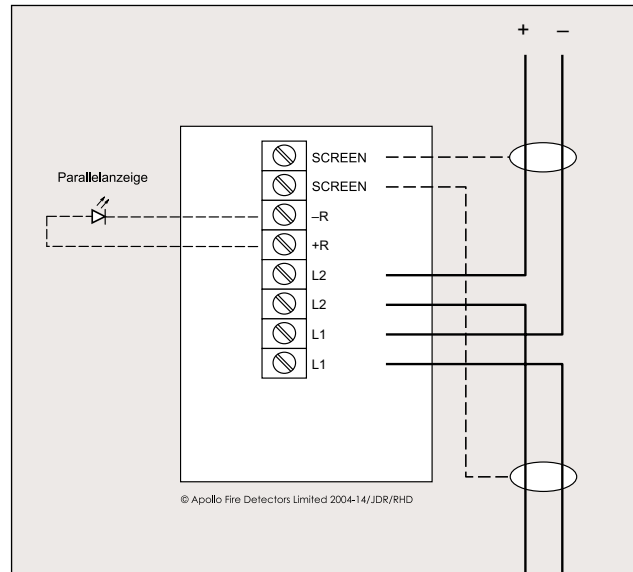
Luftkanalmeldergehäuse in Ringbustechnik
